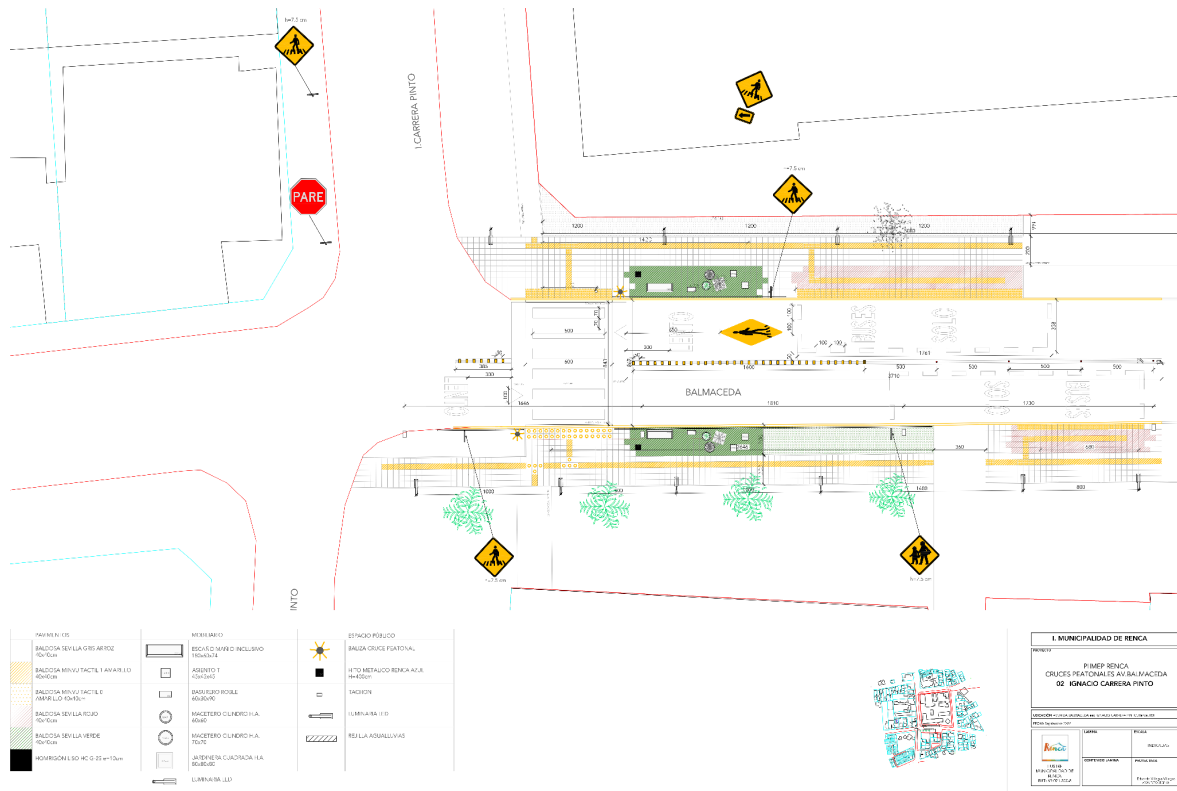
Planta AY cruce Ignacio Carrera Pinto
